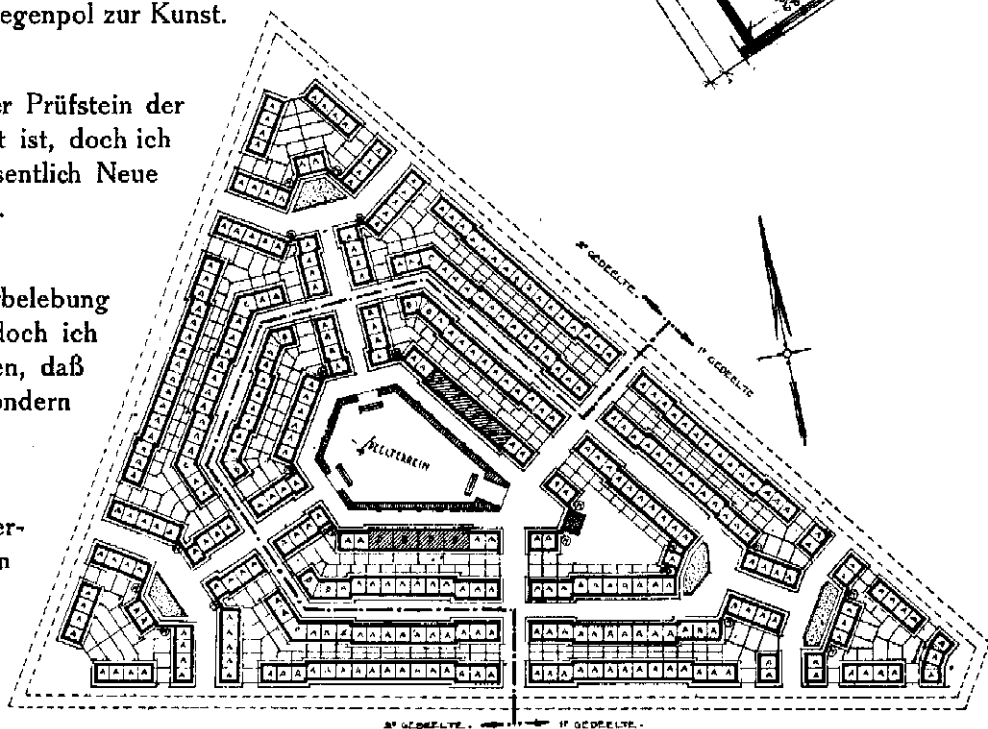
/ Einzelgrundrisse, Balkenlagen, Lageplan / „Oud-Mathenesse“, Rotterdam / (Erbaut 1922) Vgl. S. 144-45
